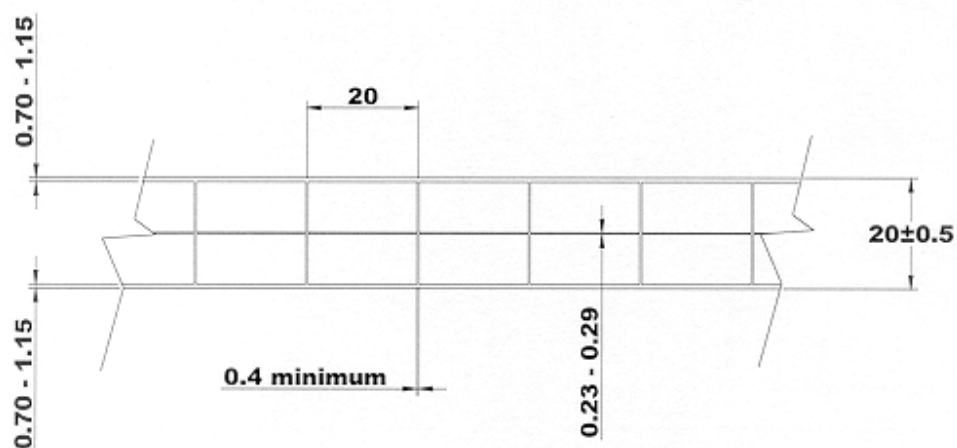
Coupe des vitrages organiques multiparois MARLON ST LONGLIFE (cotes en mm)
